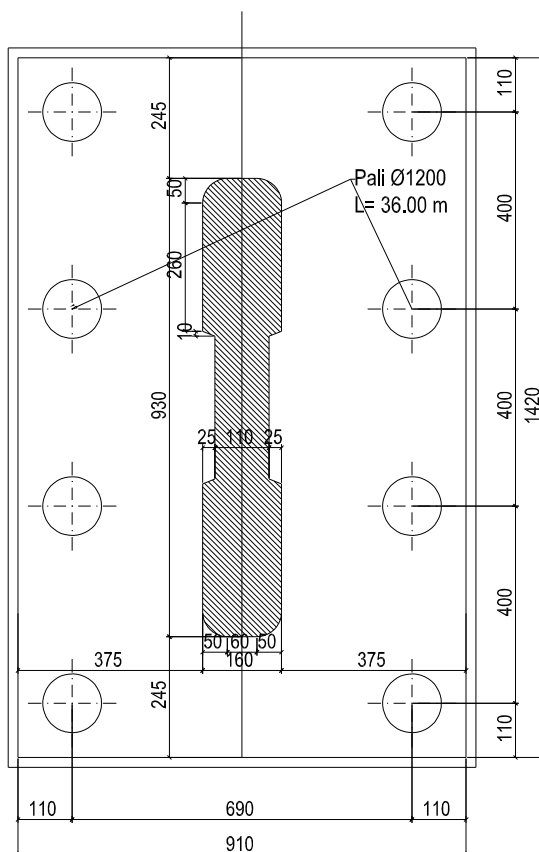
Planimetria dei pali delle pile 1 e 2
